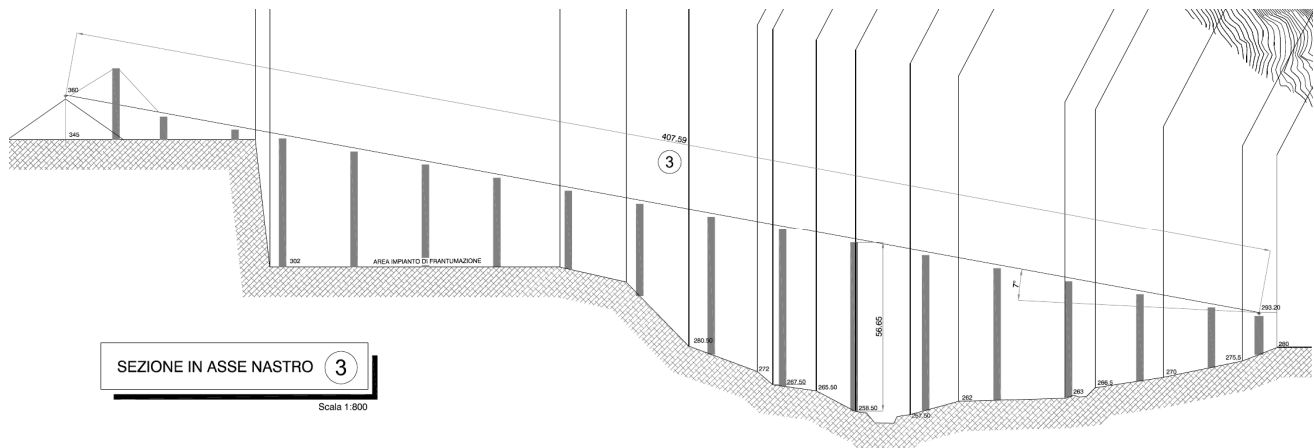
Profilo del nastro con indicazione delle pile nel P.D nel tratto in attraversamento del Torrente Verde.
